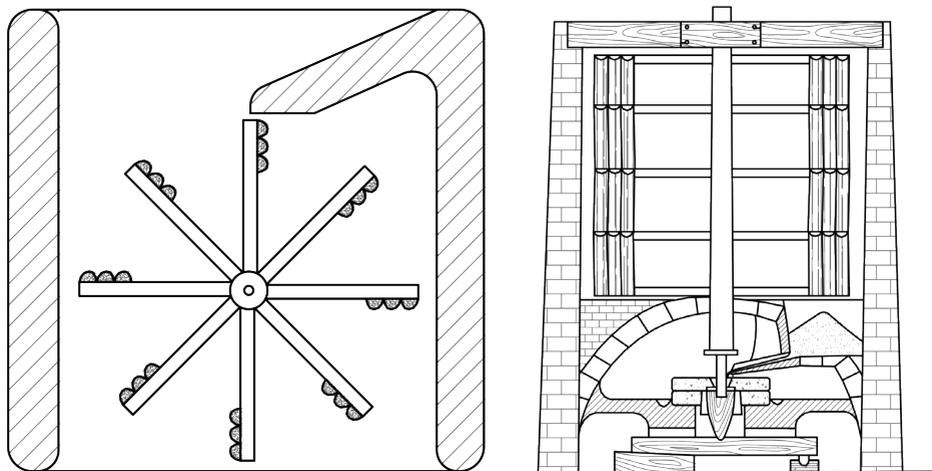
Persische Windmühle, Grundriss (links) und Schnitt (rechts)
